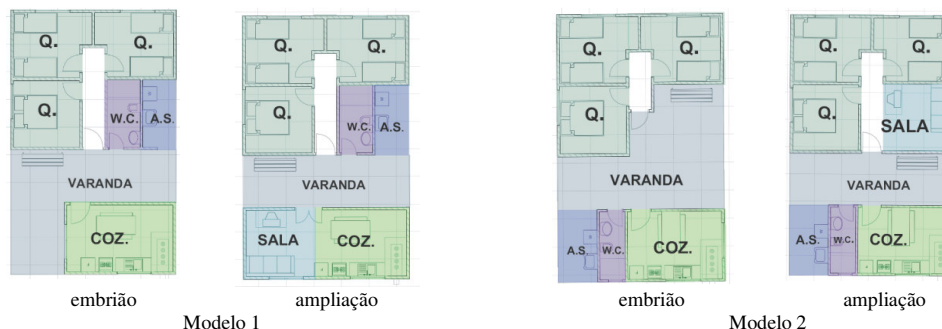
Ensaios sobre a disposição de ambientes em planta para um projeto de habitação rural – 80m².
